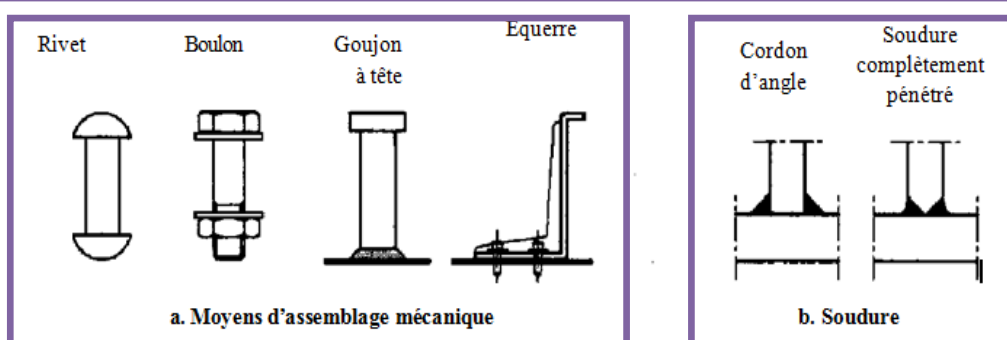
moyens d'assemblages mécanique et soudure.
